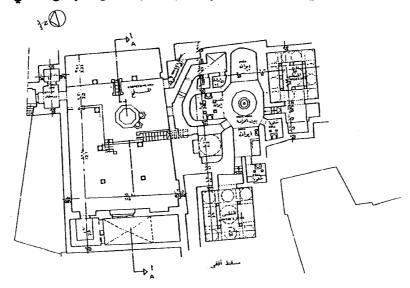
مسقط أفقي لحمام يشتاك بالقاهرة. (عن المجلس الأعلي للآثار).
